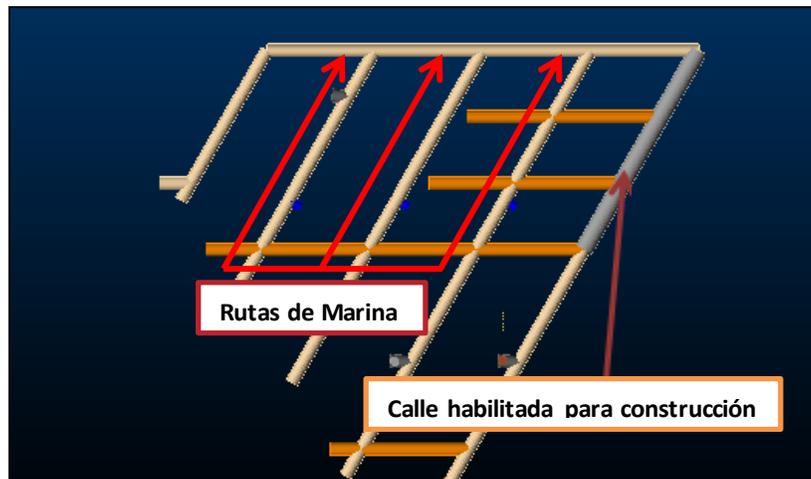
Criterios de Constructibilidad, Constructibilidad de Calles
